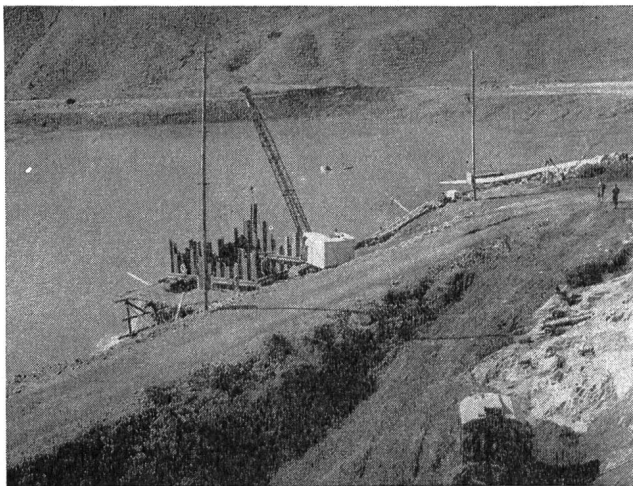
Abgesenkter Melchsee mit Seeanstich und Heberleitung; im Vordergrund Baugrube des Dammbaus mit anstehendem Quintenerkalk (Photo C. Abächerli, Sarnen)
